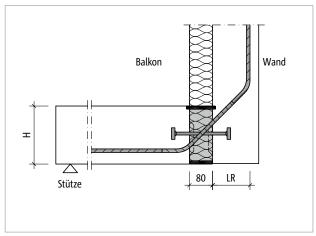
Schöck Isokorb $^{\otimes}$ T Typ QP-WO: Wandanschluss nach oben bei Außendämmung
